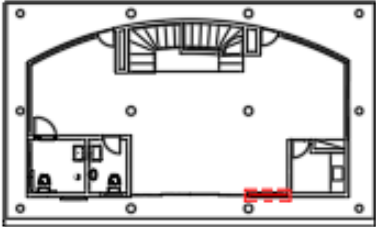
FIDs do pavimento térreo (PT) (continuação)
